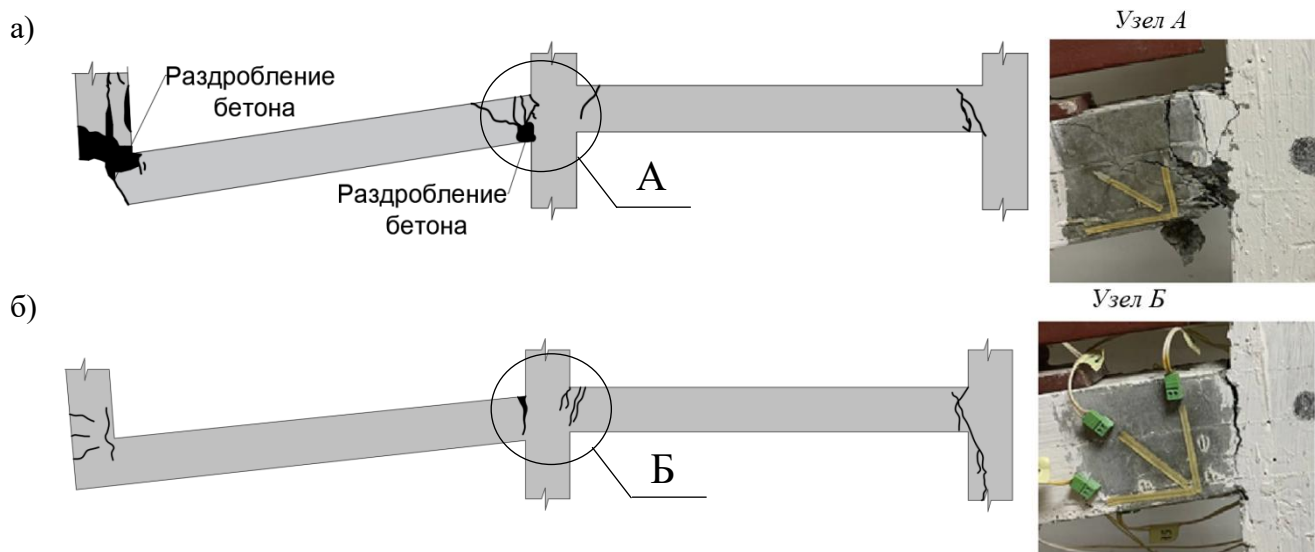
Картина разрушения ригелей над первым этажом опытных рам, армированных наклонными РЖ-1(а) и перекрестными РЖ-2 (б) стержнями
